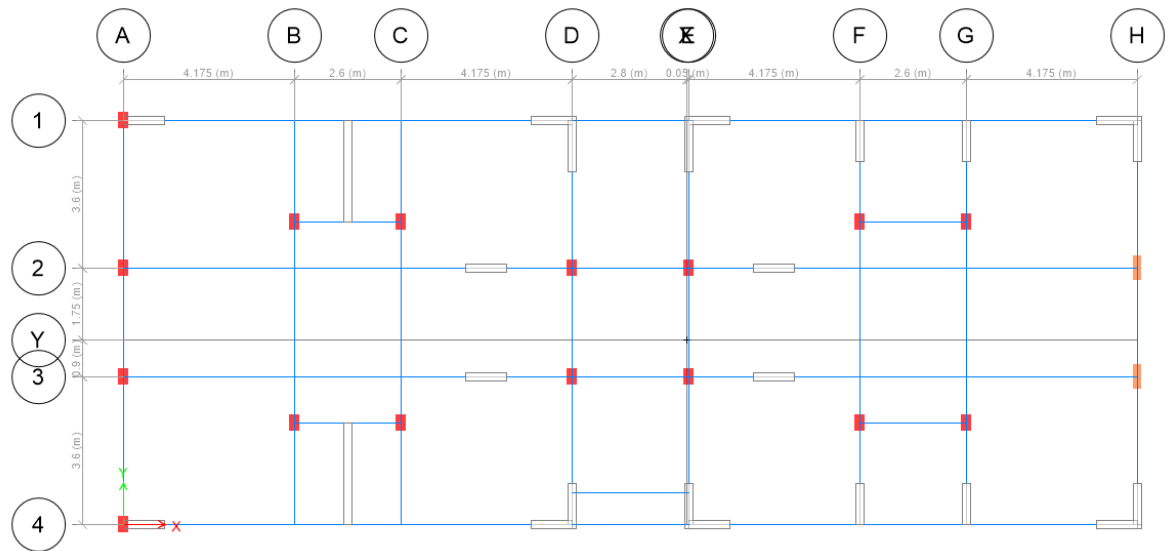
Planta de Estructuración modelado en el software ETABS V16.2.1
